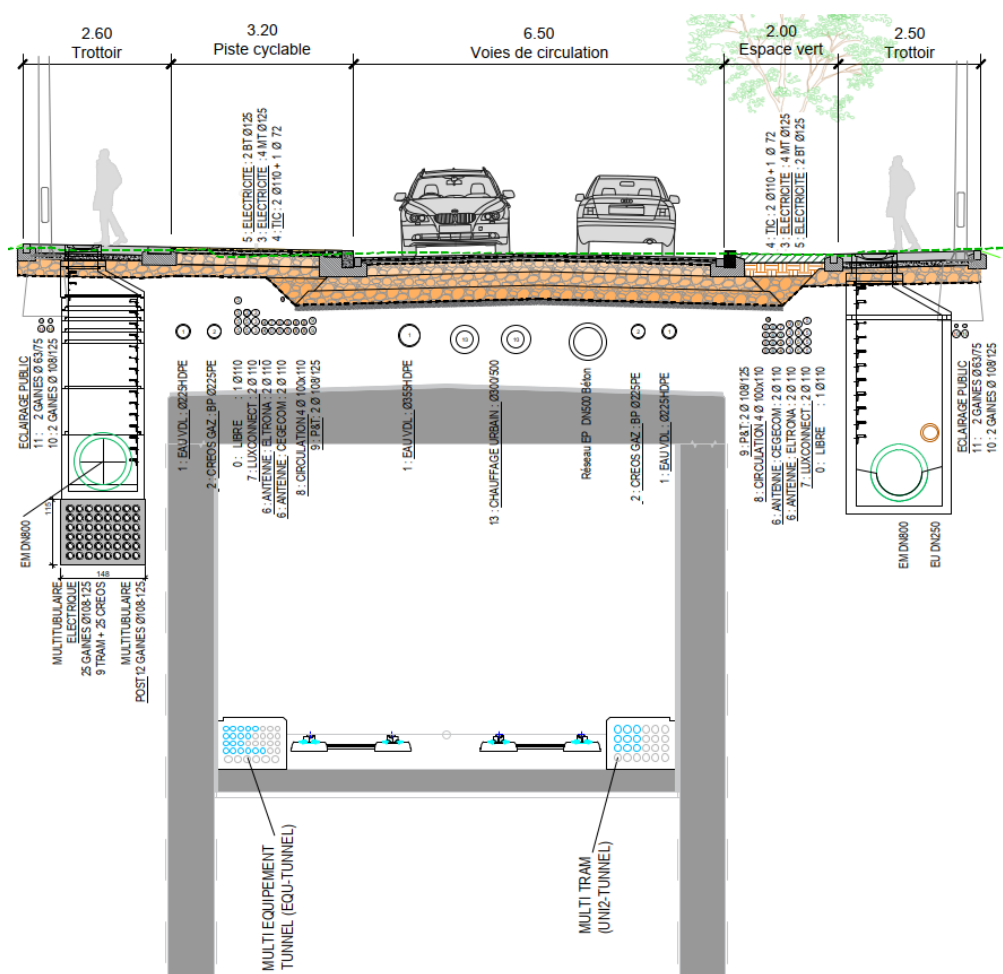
Coupe transversale schématique de la tranchée couverte de la route d'Arlon. Source : APS Groupement 2024
